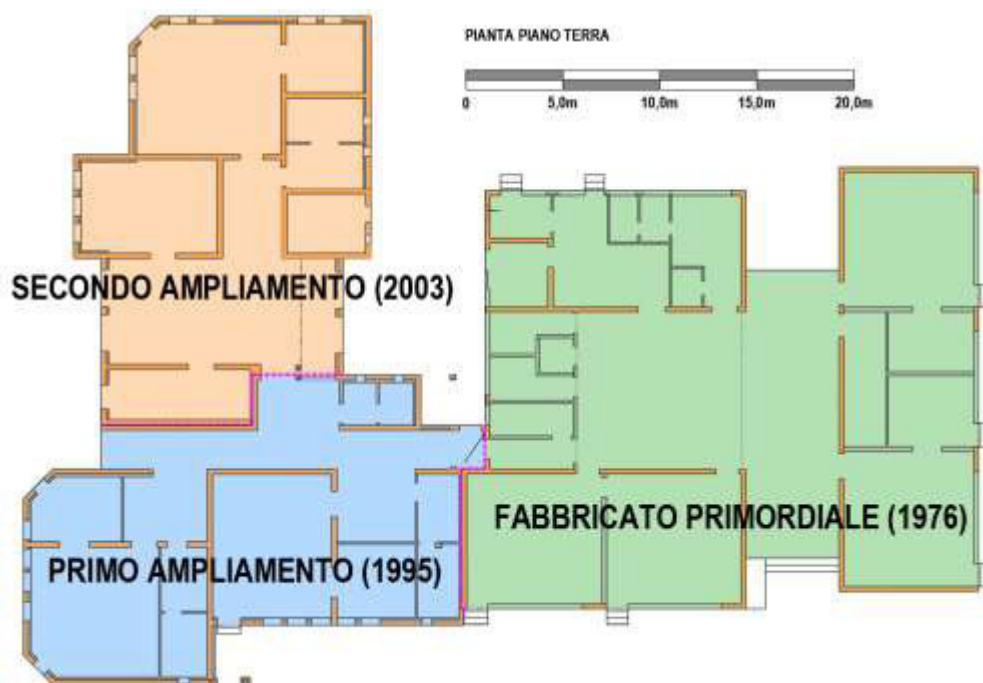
Planimetria fabbricato con individuazione degli ampliamenti
